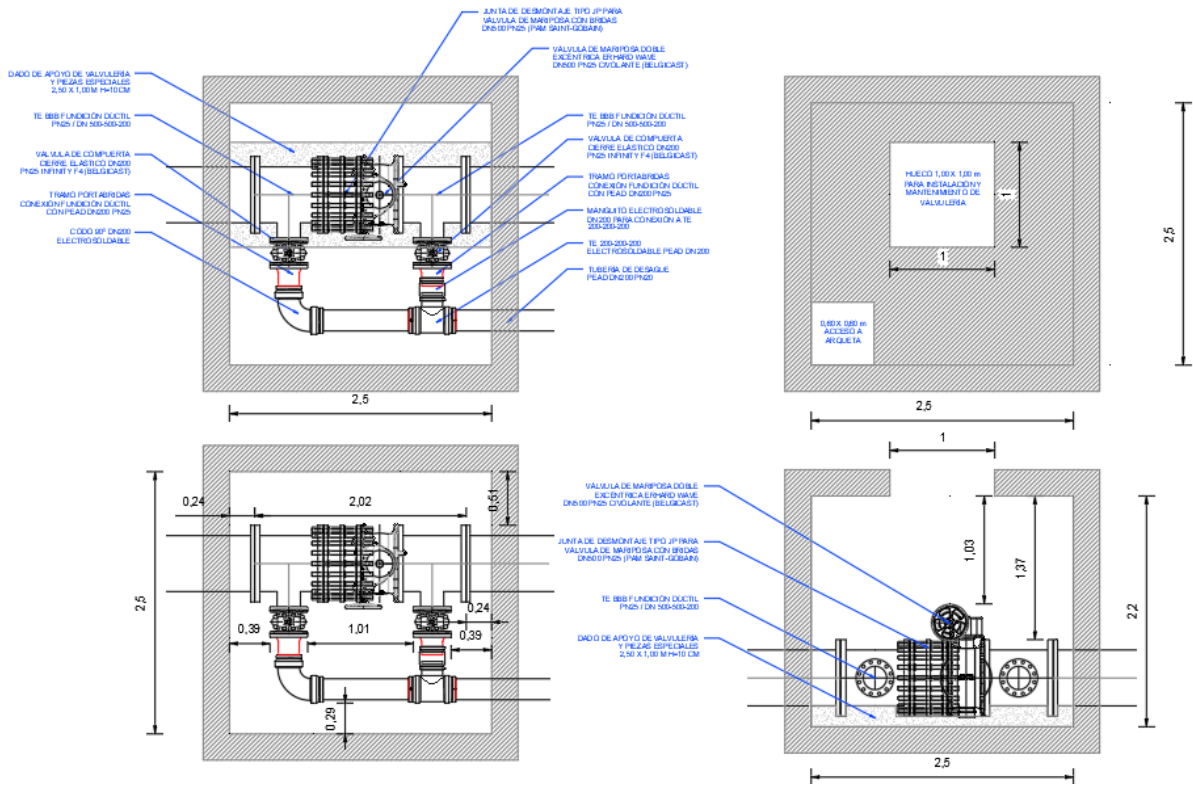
Planta General de la Arqueta de Desagüe. Fuente: Elaboración propia
